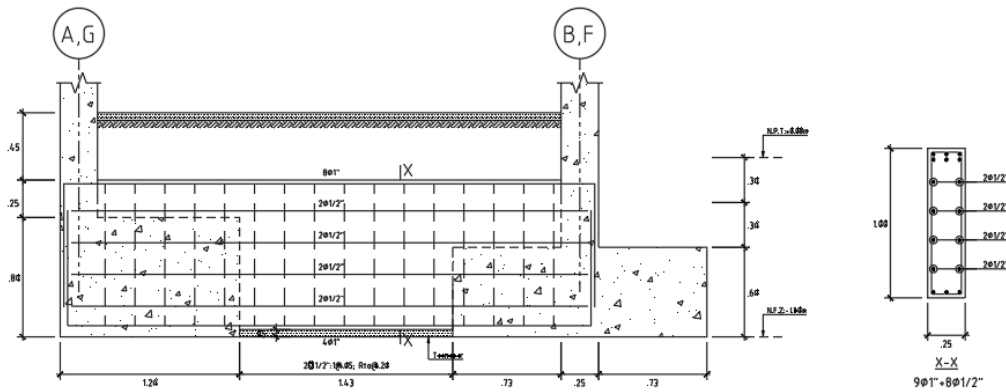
Detalle de refuerzo de la viga de cimentación VC-01.
